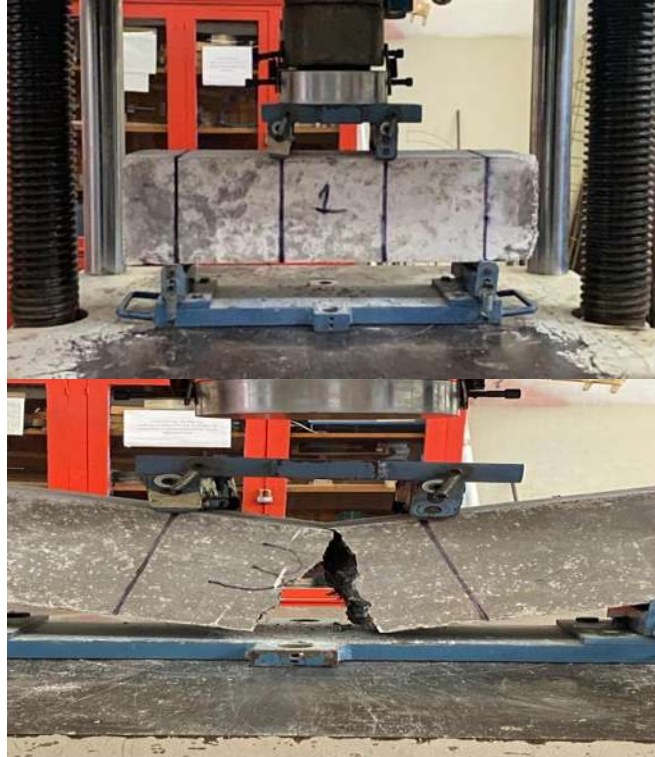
prueba para obtener el módulo de ruptura del concreto. Fuente propia
